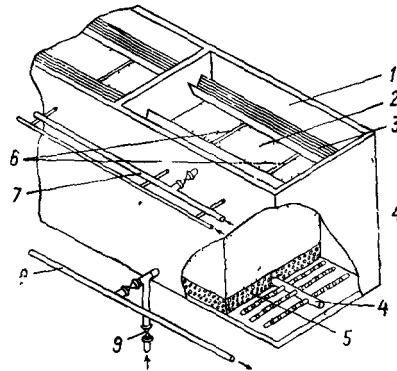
Схема безнапорного железобетонного адсорбера:
